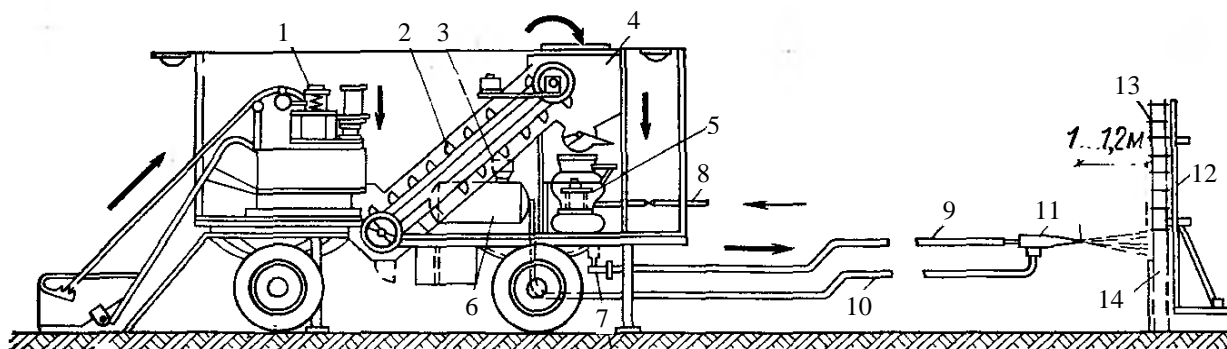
Установка для набрызк-бетону: 1 – змішувач; 2 – нахильний елеватор; 3, 6 – бак для води; 4 – витратний бункер; 5 – набрызк-машина; 7 – вихідний штуцер; 8 – рукав для подавання повітря від компресора; 9 – рукав для подавання матеріалів; 10 – рукав для води; 11 – насадка; 12 – опалубка; 13 – арматура; 14 – набрызк-бетон
